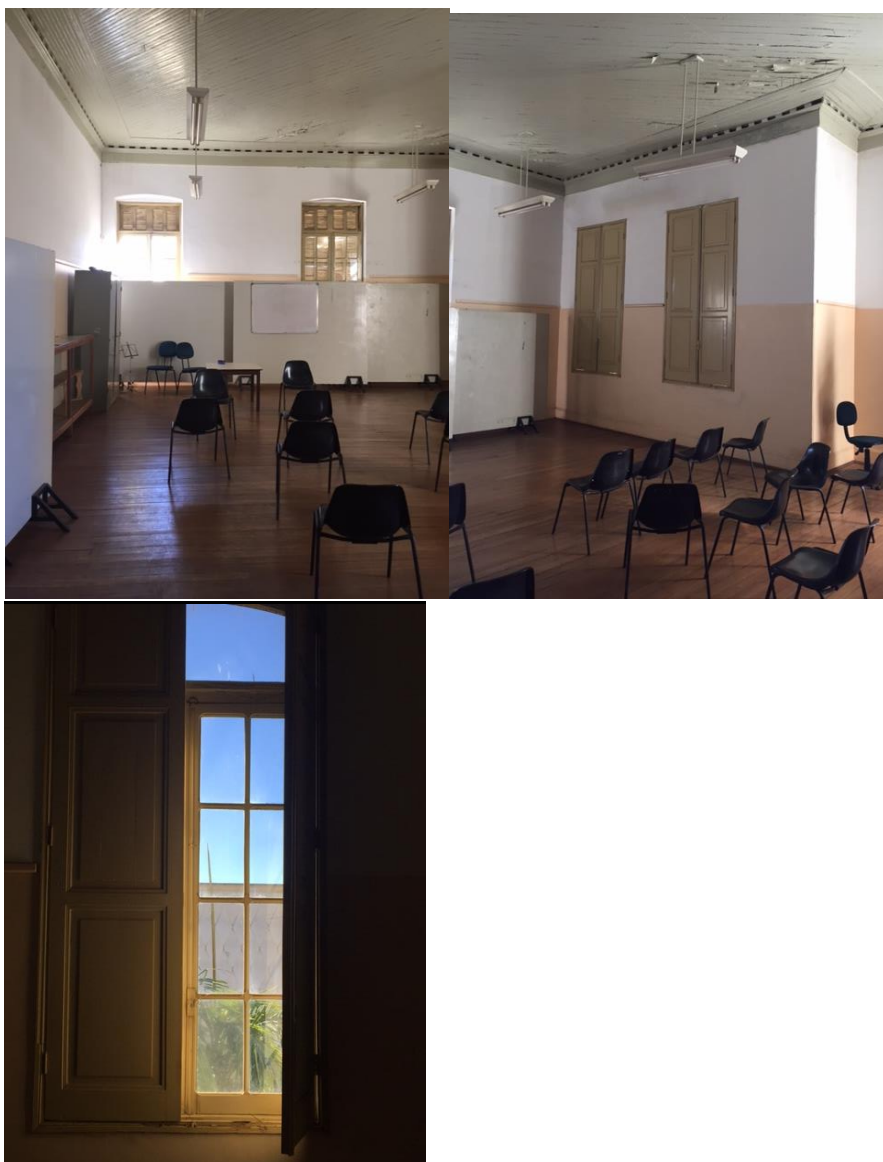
e 56 – Pinacoteca. Neste ambiente haverá janelas que serão restauradas e outras serão retiradas e substituídas por novas no mesmo padrão. As portas serão restauradas. Paredes, forro e piso segue o já descrito.
